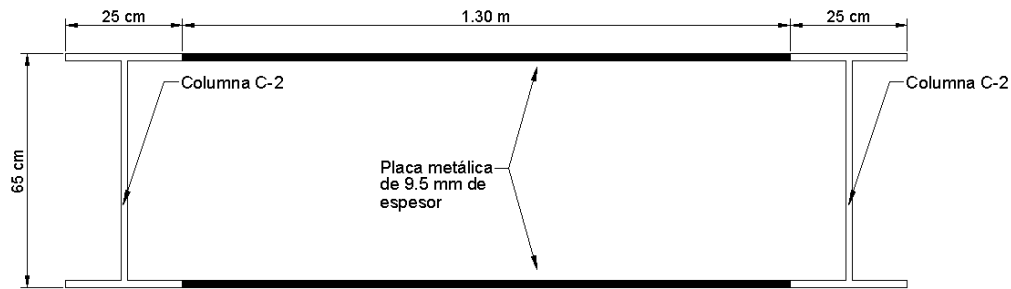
Contraventeo en nudo de columna principal (vista en planta)
